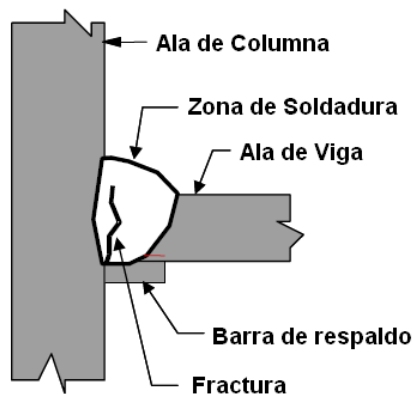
Detalle de falla típica de conexión viga-columna (FEMA-350, 2000)
